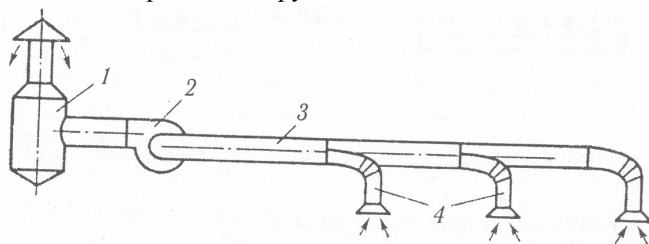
Схема витяжної вентиляції: 1 – очисний пристрій, 2 – вентилятор, 3 – центральний та 4 – відсмоктувальний повітроводи
